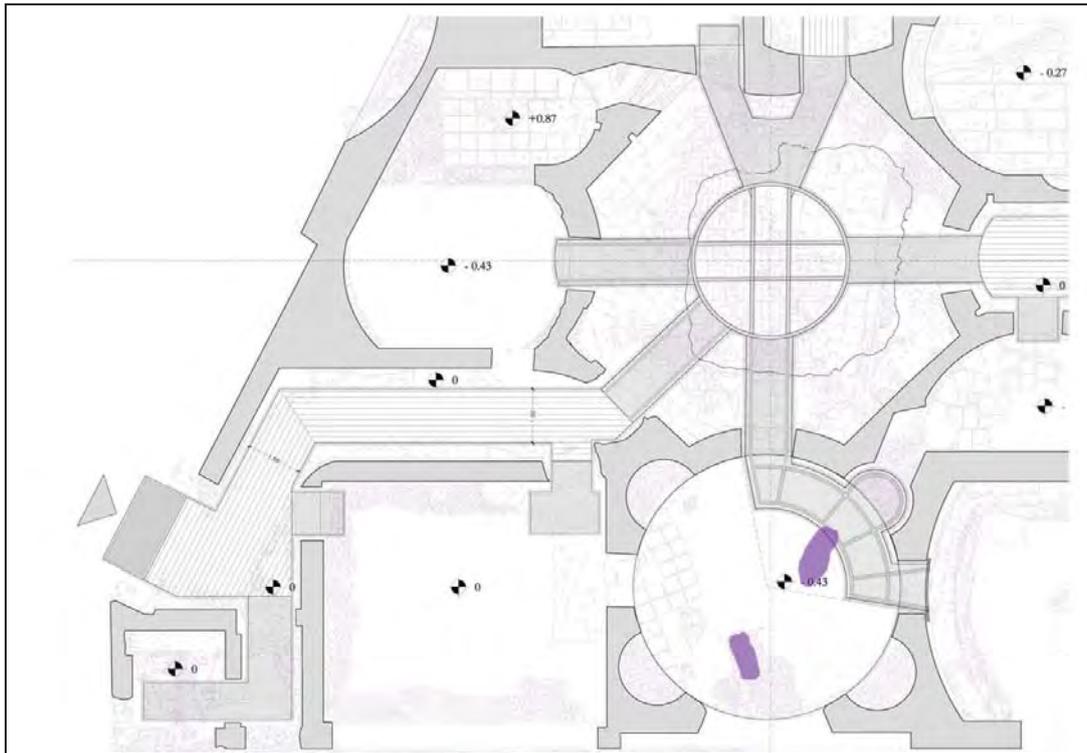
Particolare della passerella ponte, con l'area centrale in cristallo, progettata per musealizzare le impronte dell'originario pavimento in opus sectile, ipotizzata in variante alla passerella con attraversamento perimetrale appoggiata sul sedime archeologico per l'attraversamento della Sala Ottagona.
